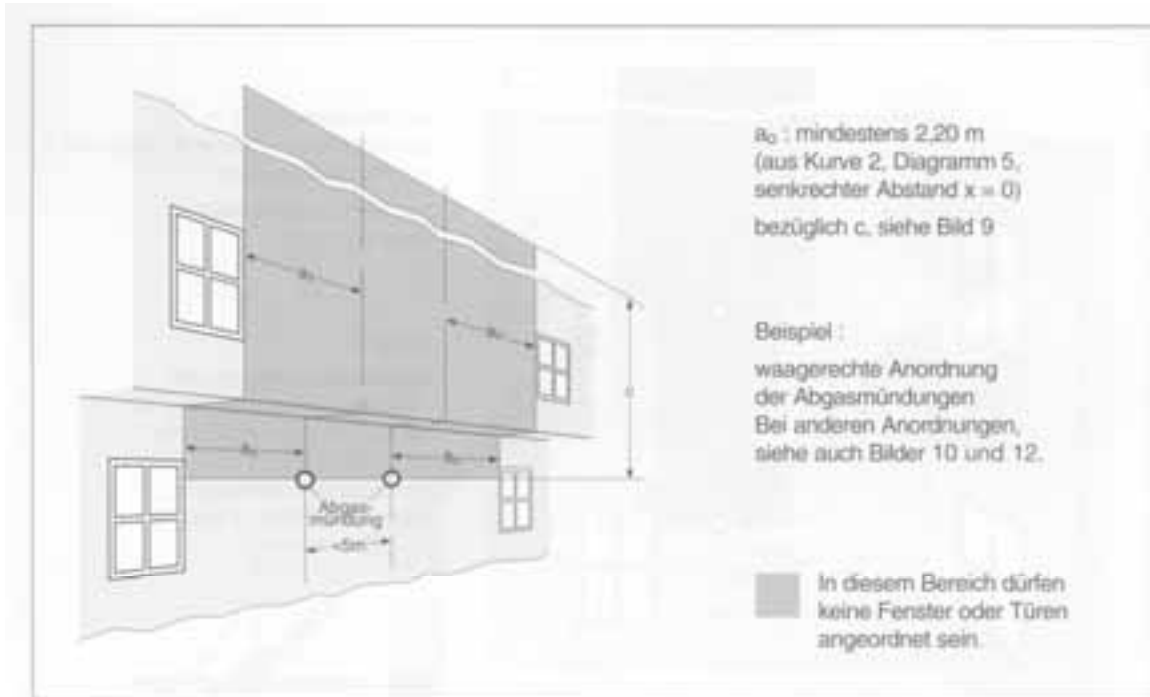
Mindestabstände von Abgasmündungen einer Zweier-Gruppe zu Fenstern, die geöffnet werden können, oder Fassadentüren – bei Fassaden mit Vorsprung
